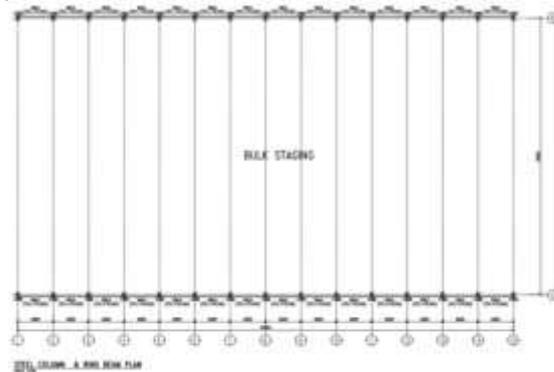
Denah Kolom Baja Warehouse PPLI Bentang 30 meter
